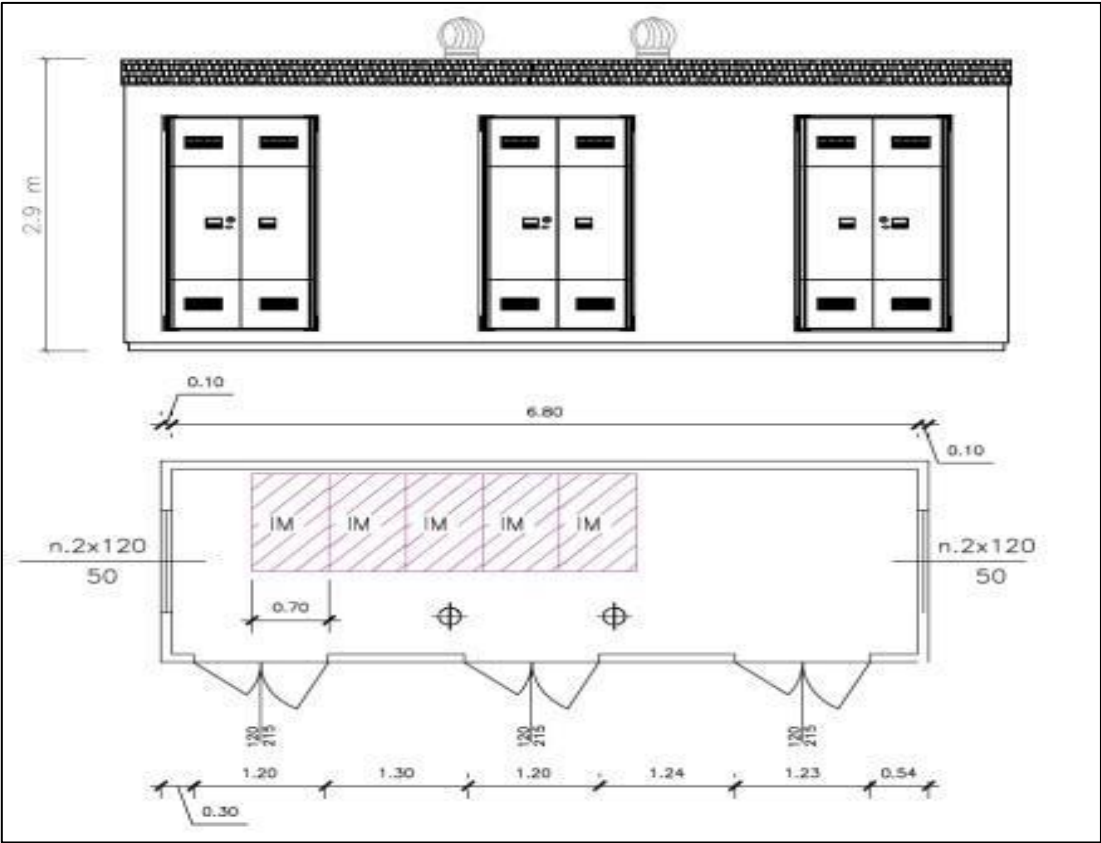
Prospetti e planimetria della cabina di sezionamento – Elaborato grafico di riferimento SLC 060
